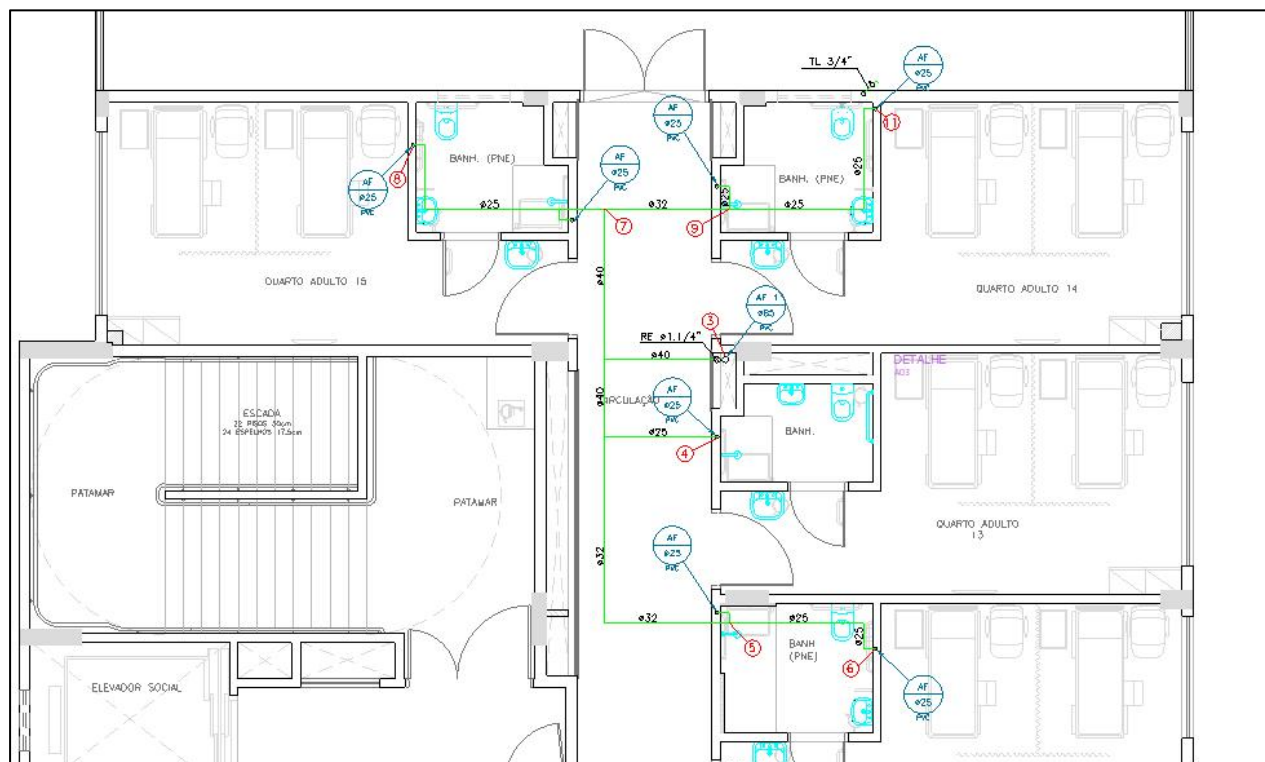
BARRILETE 4º PAVIMENTO - Pontos 3 ao 9 e 11 selecionados.
